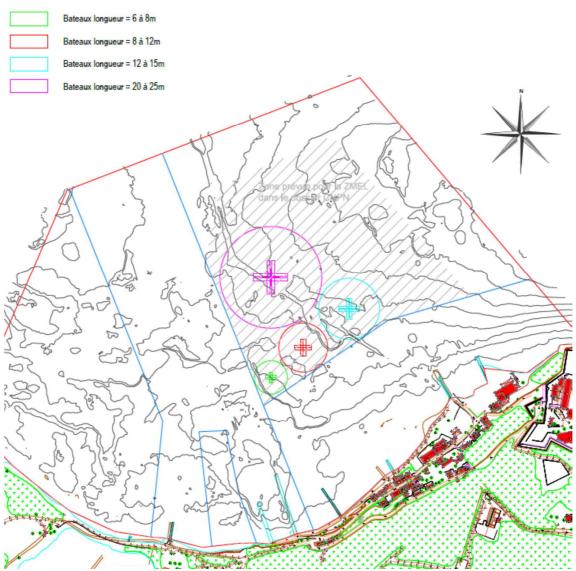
Plan masse du scénario 3 : amarrage sur fleur de mouillage
